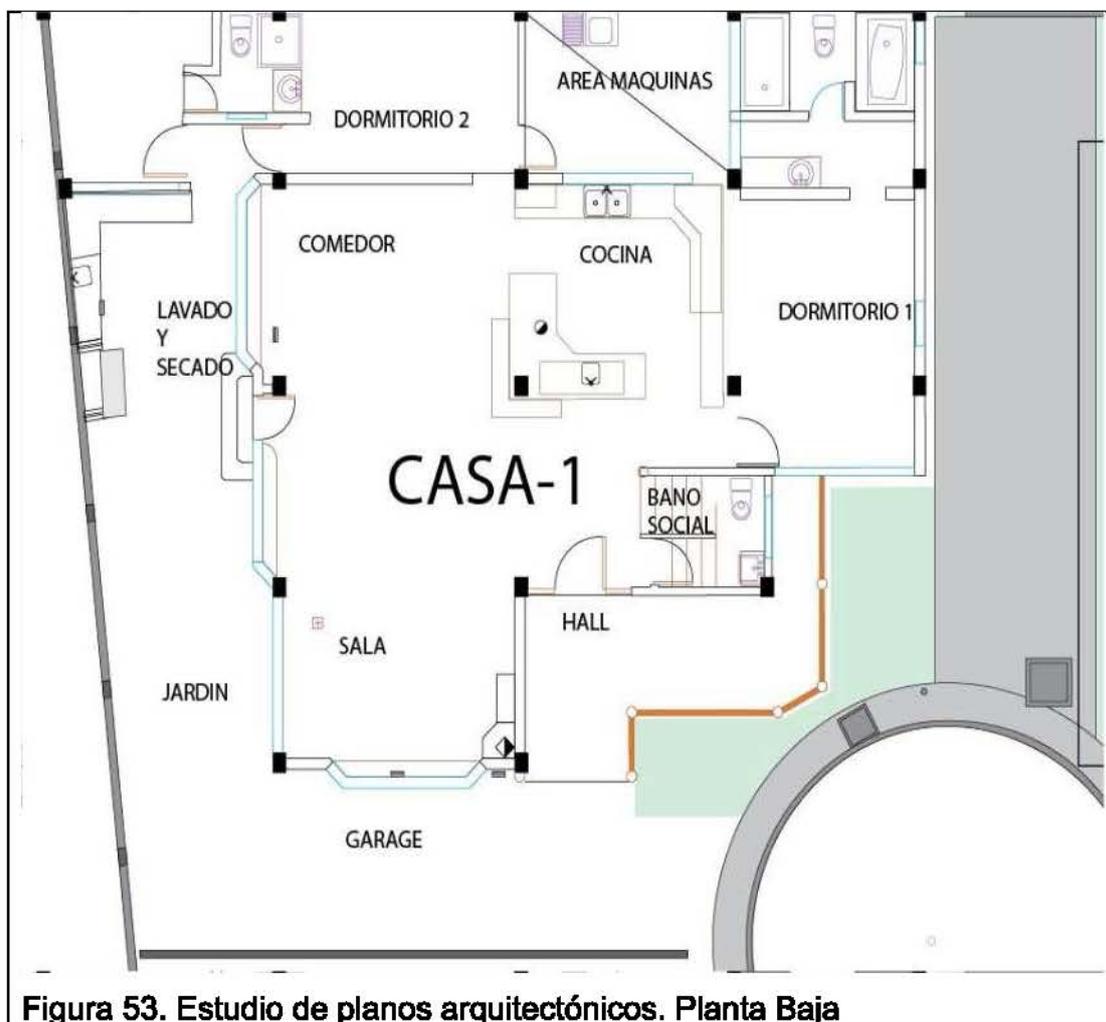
Estudio de planos arquitectónicos. Planta Baja
